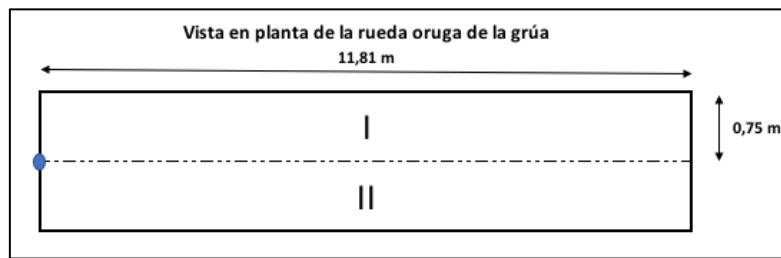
Vista en planta de la rueda de oruga. (*Fuente:* elaboración propia.)
